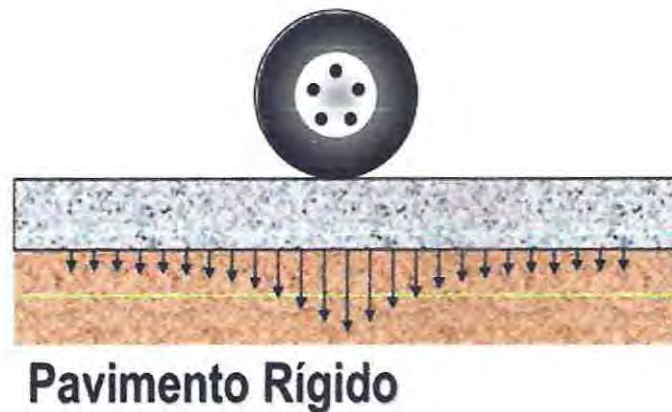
Distribución de cargas de pavimentos rígidos.
